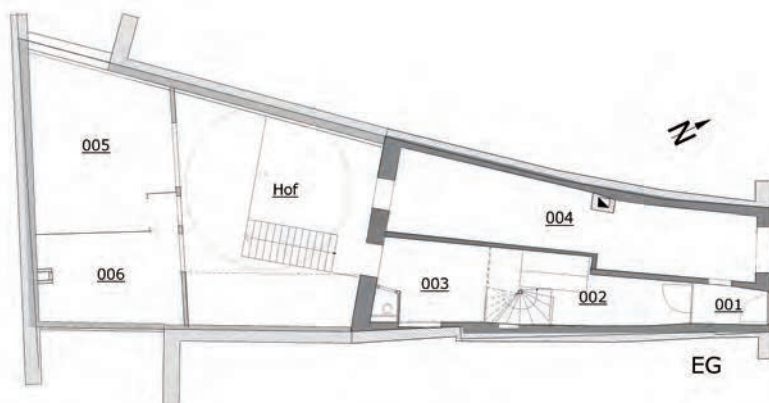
Klosterberg 9. Grundrissplan EG vor dem Umbau. Links die Werkstatt. – Plan: Kapp Architekten, Basel. Bearbeitung: Matthias Merki.
